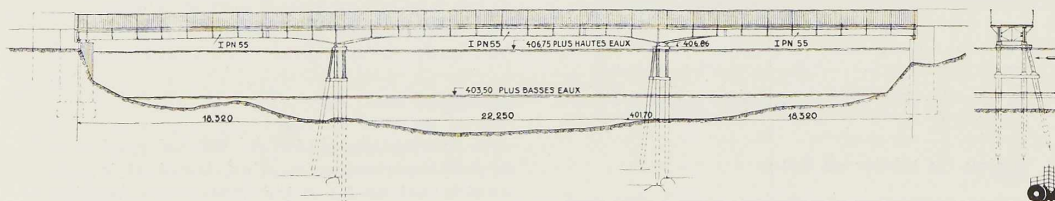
Vue en élévation et coupe transversale de la passerelle de Zurich fondée sur des poutrelles à larges ailes.
